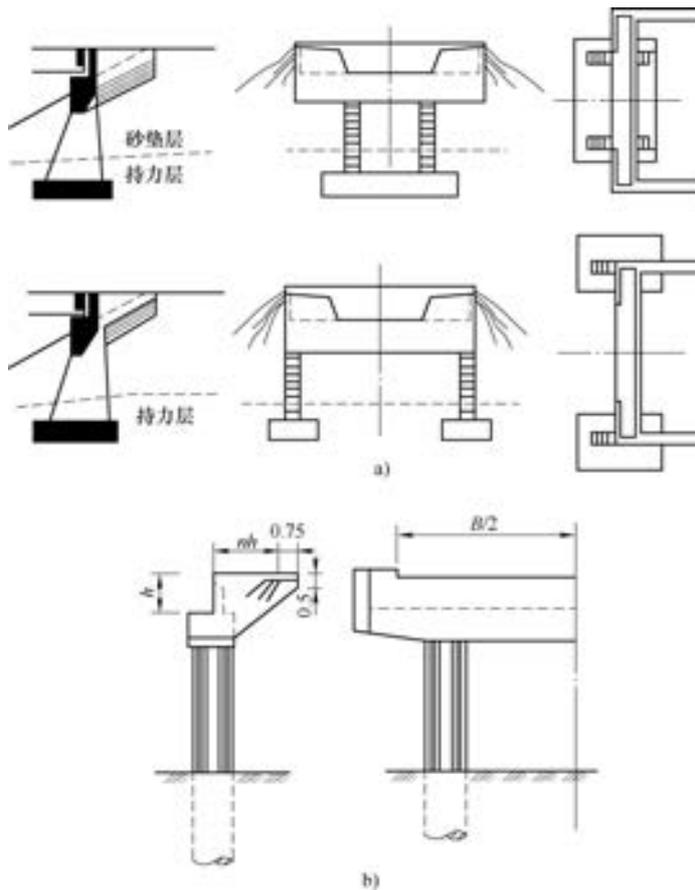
钢筋混凝土肋板(柱)框架桥示意图
